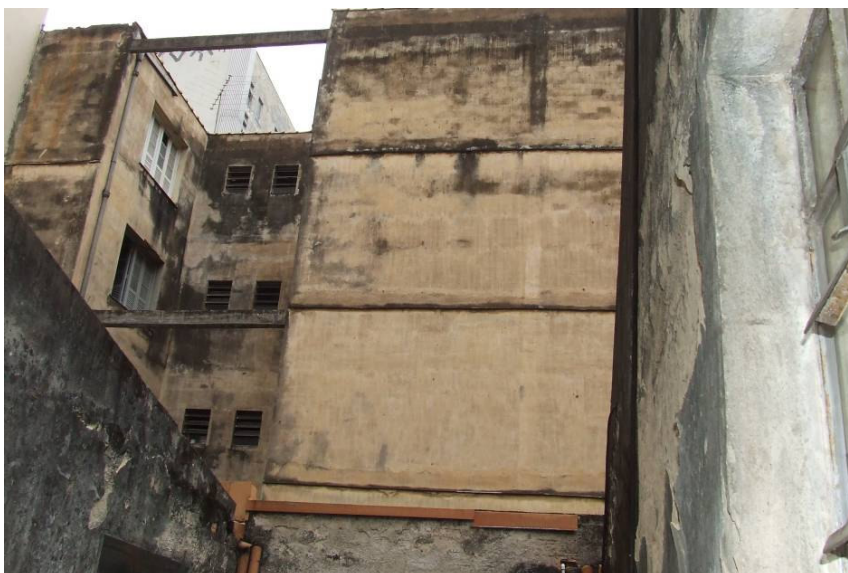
Vista da fachada lateral. Revestimento em pintura.
